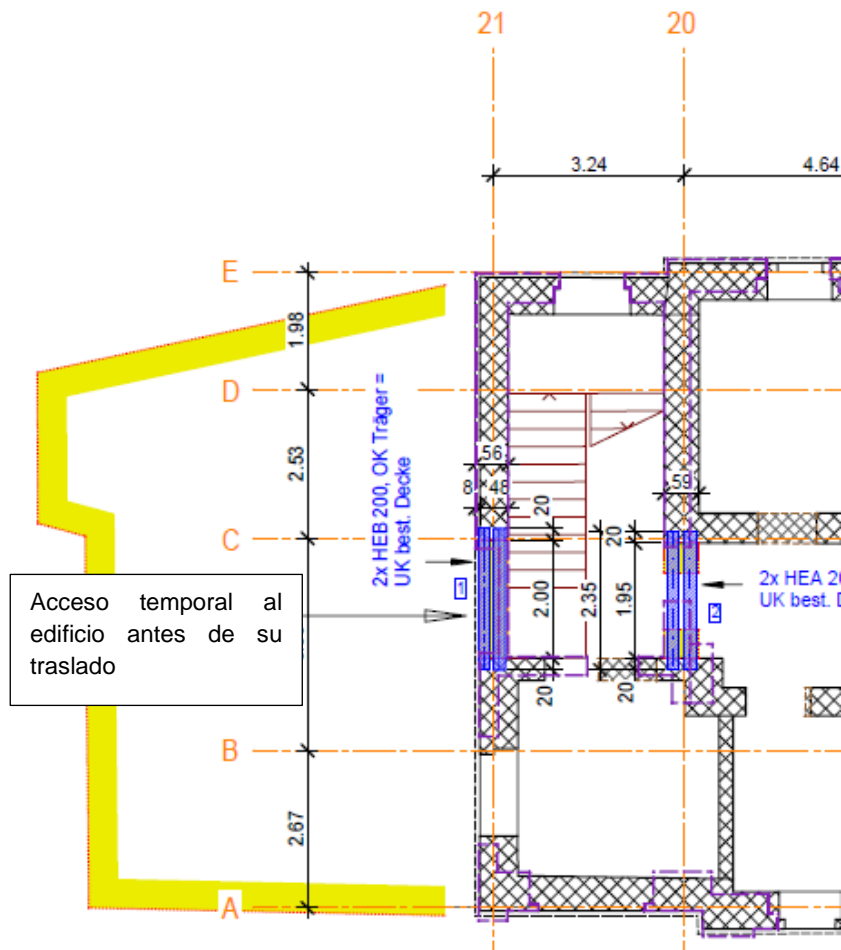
, Plano parcial con eje 20 y 21 / apertura y anexo a derribar (amarillo)
